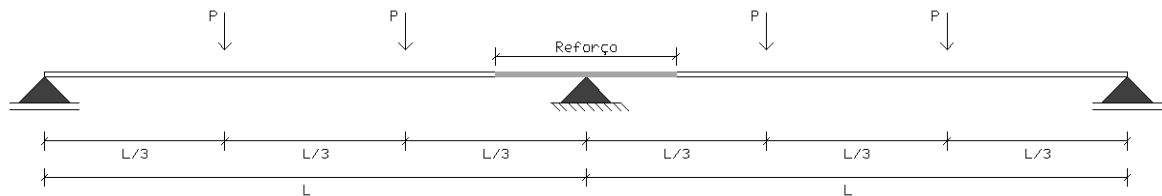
Esquema de ensaio de flexão simples – Ensaio 3.
